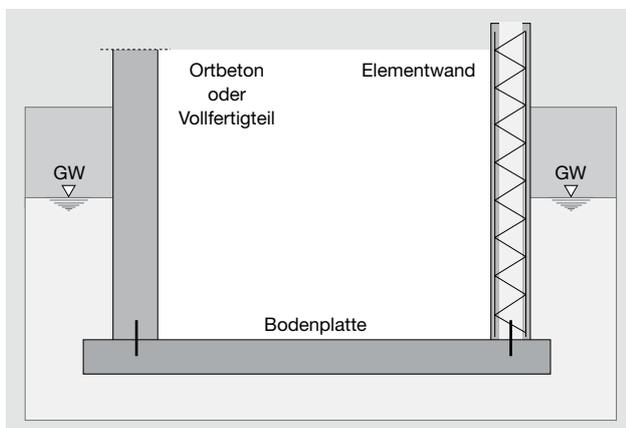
Wasserundurchlässige Bauwerke (Weiße Wannen) aus Beton ohne zusätzliche Abdichtung in verschiedenen Bauweisen.
